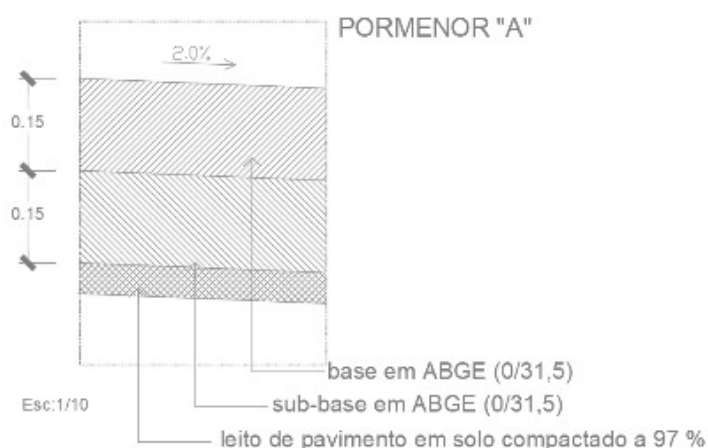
Corte tipo geral do pavimento em ABGE
